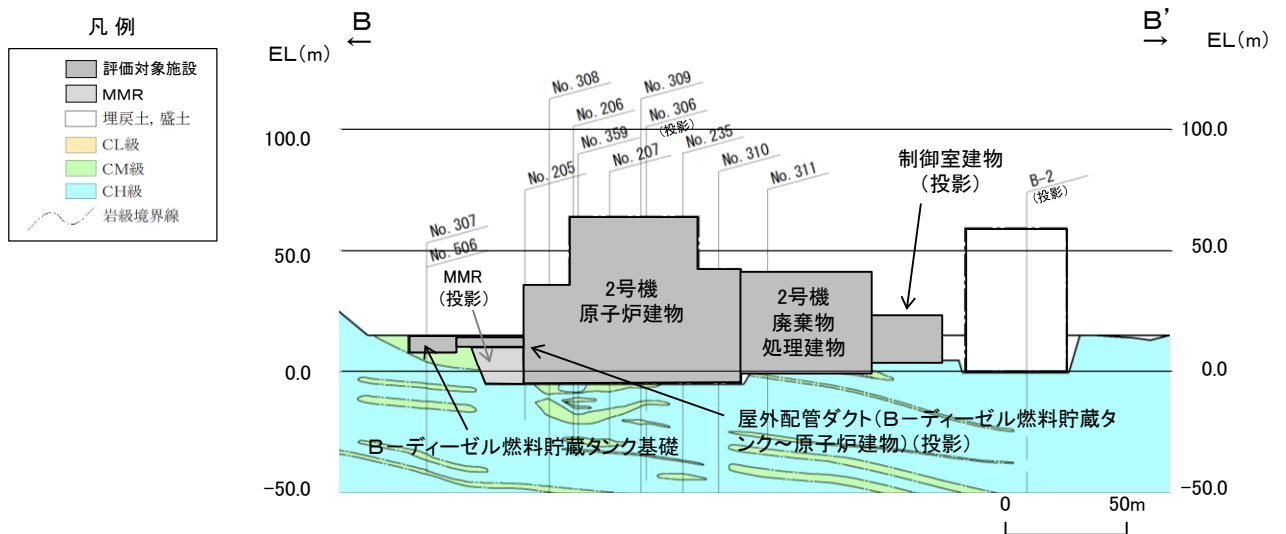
原子炉建物等の地質断面図 (B-B' 断面)
